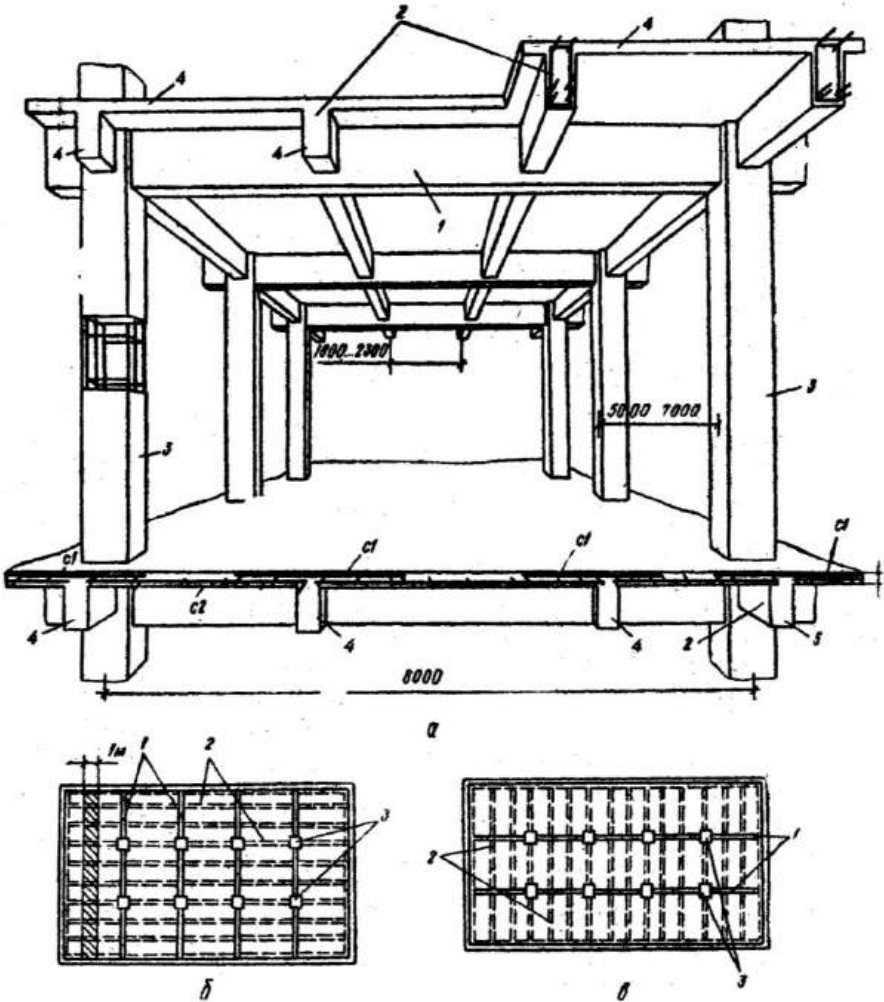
Монолітне ребристе перекриття з балковими плитами:
